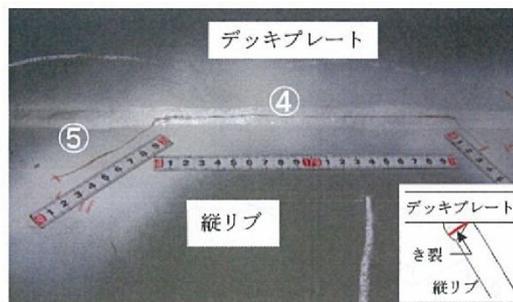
写真 B デッキプレートと縦リブの溶接部に生じたき裂
